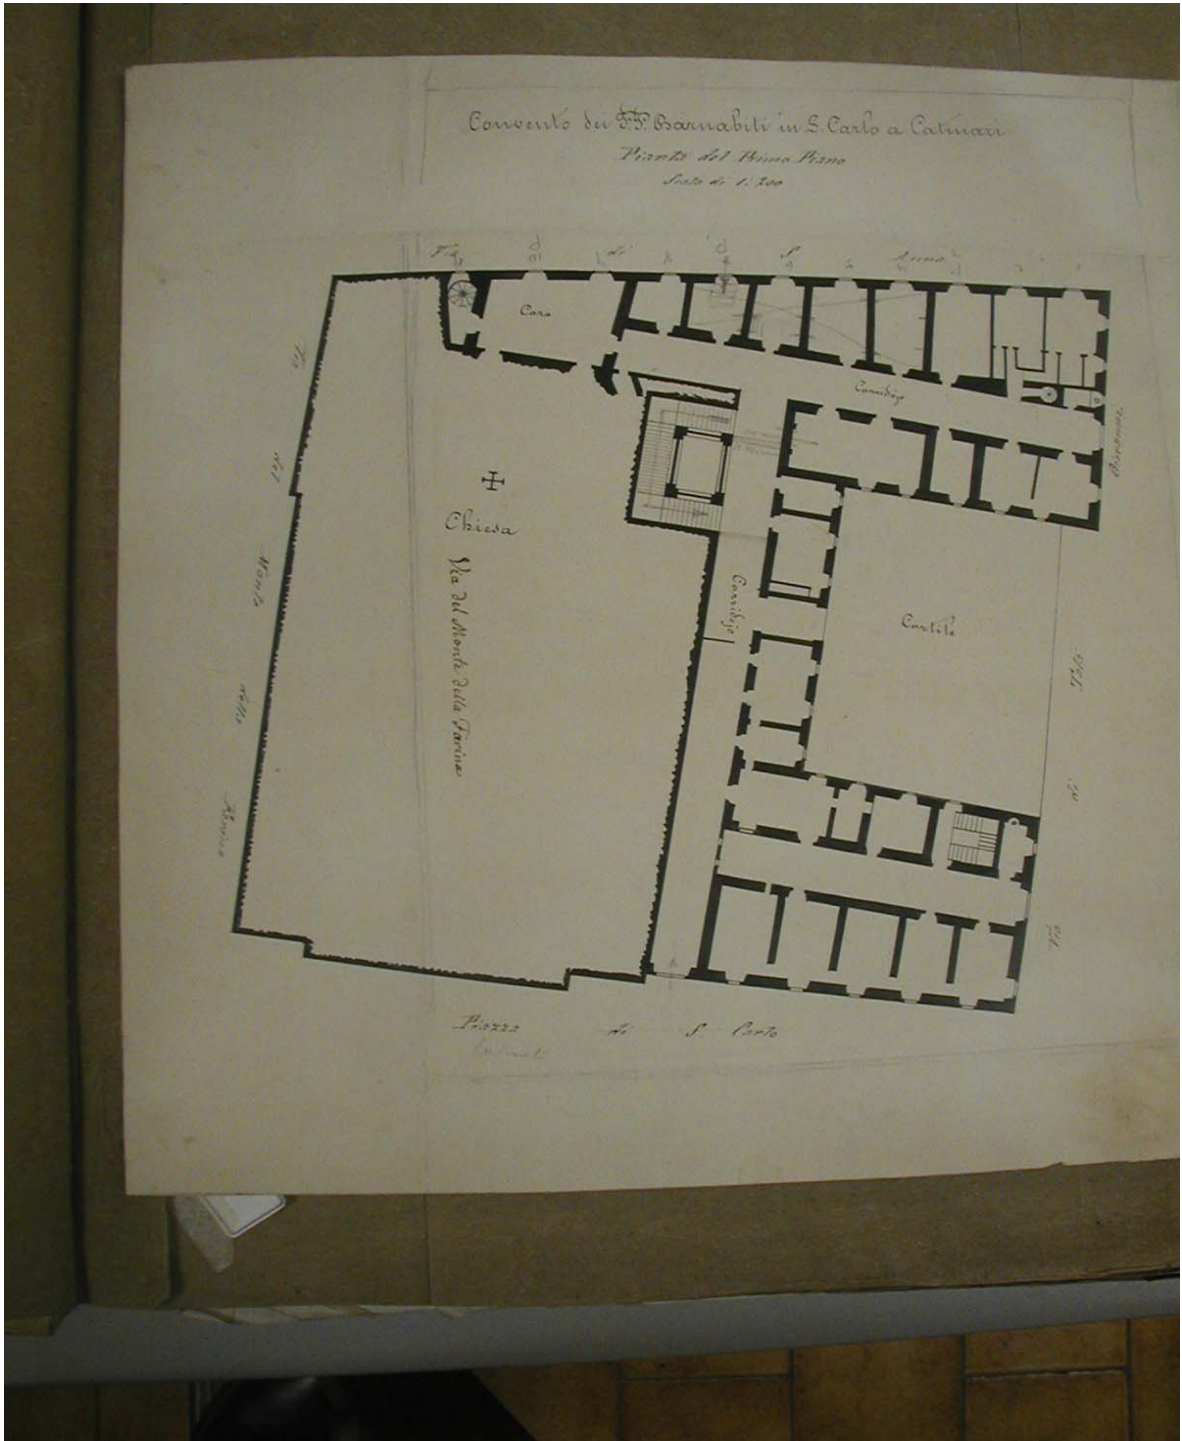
Anonimo, progetto della pianta del primo piano del Collegio (AGB).
